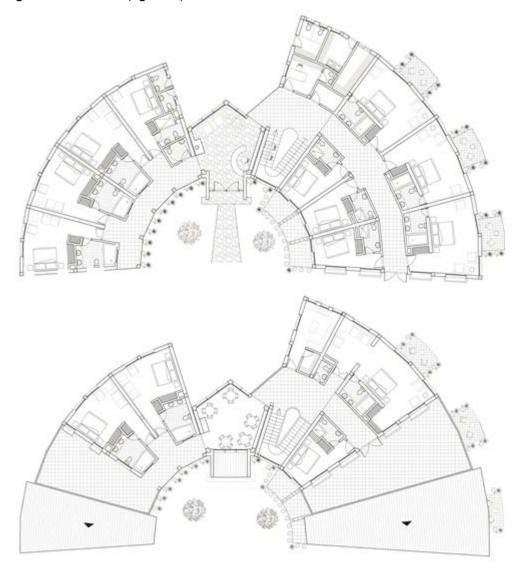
Planta arquitectónica del primero y segundo piso (Proyectista: Arq Lucia E. Garzón)
